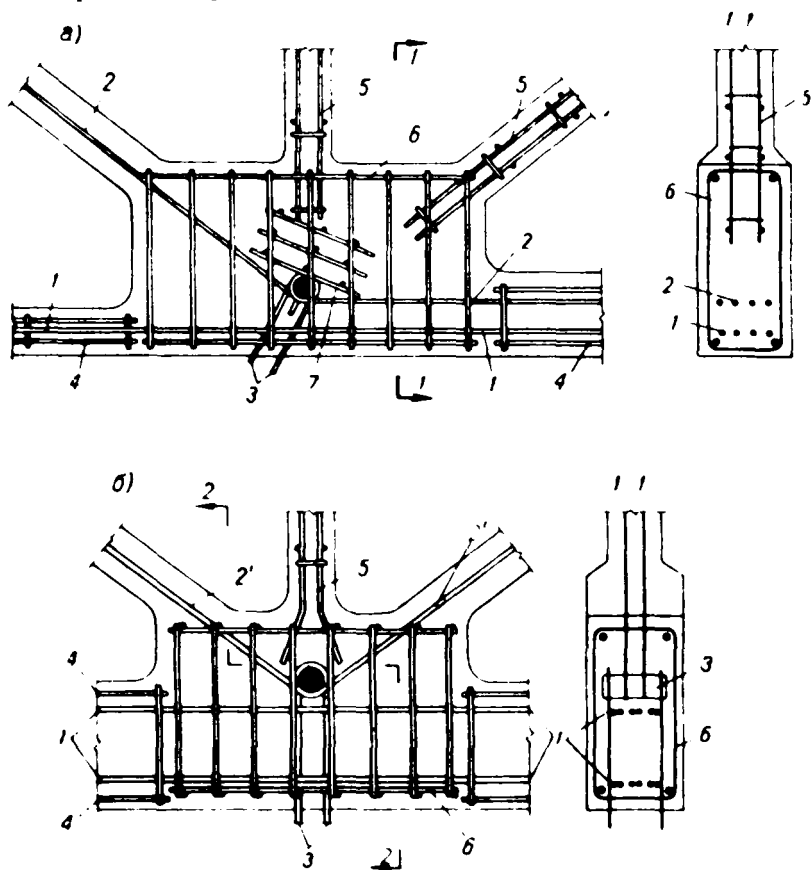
Узлы фермы с параллельными поясами с переводом напрягаемой прядевой арматуры в растянутые раскосы
